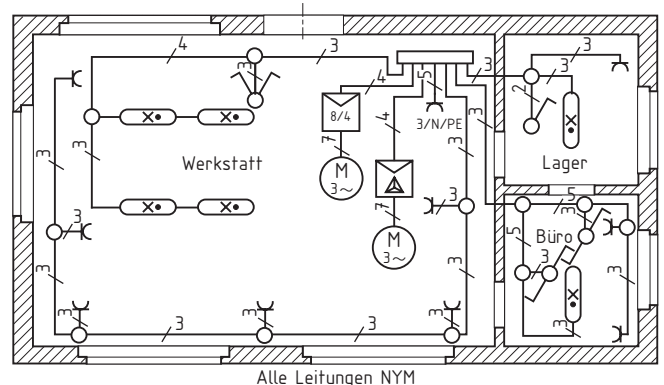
Installationsschaltplan einer Werkstatt. Betriebsmittel und Leitungen lagerichtig eingezeichnet
